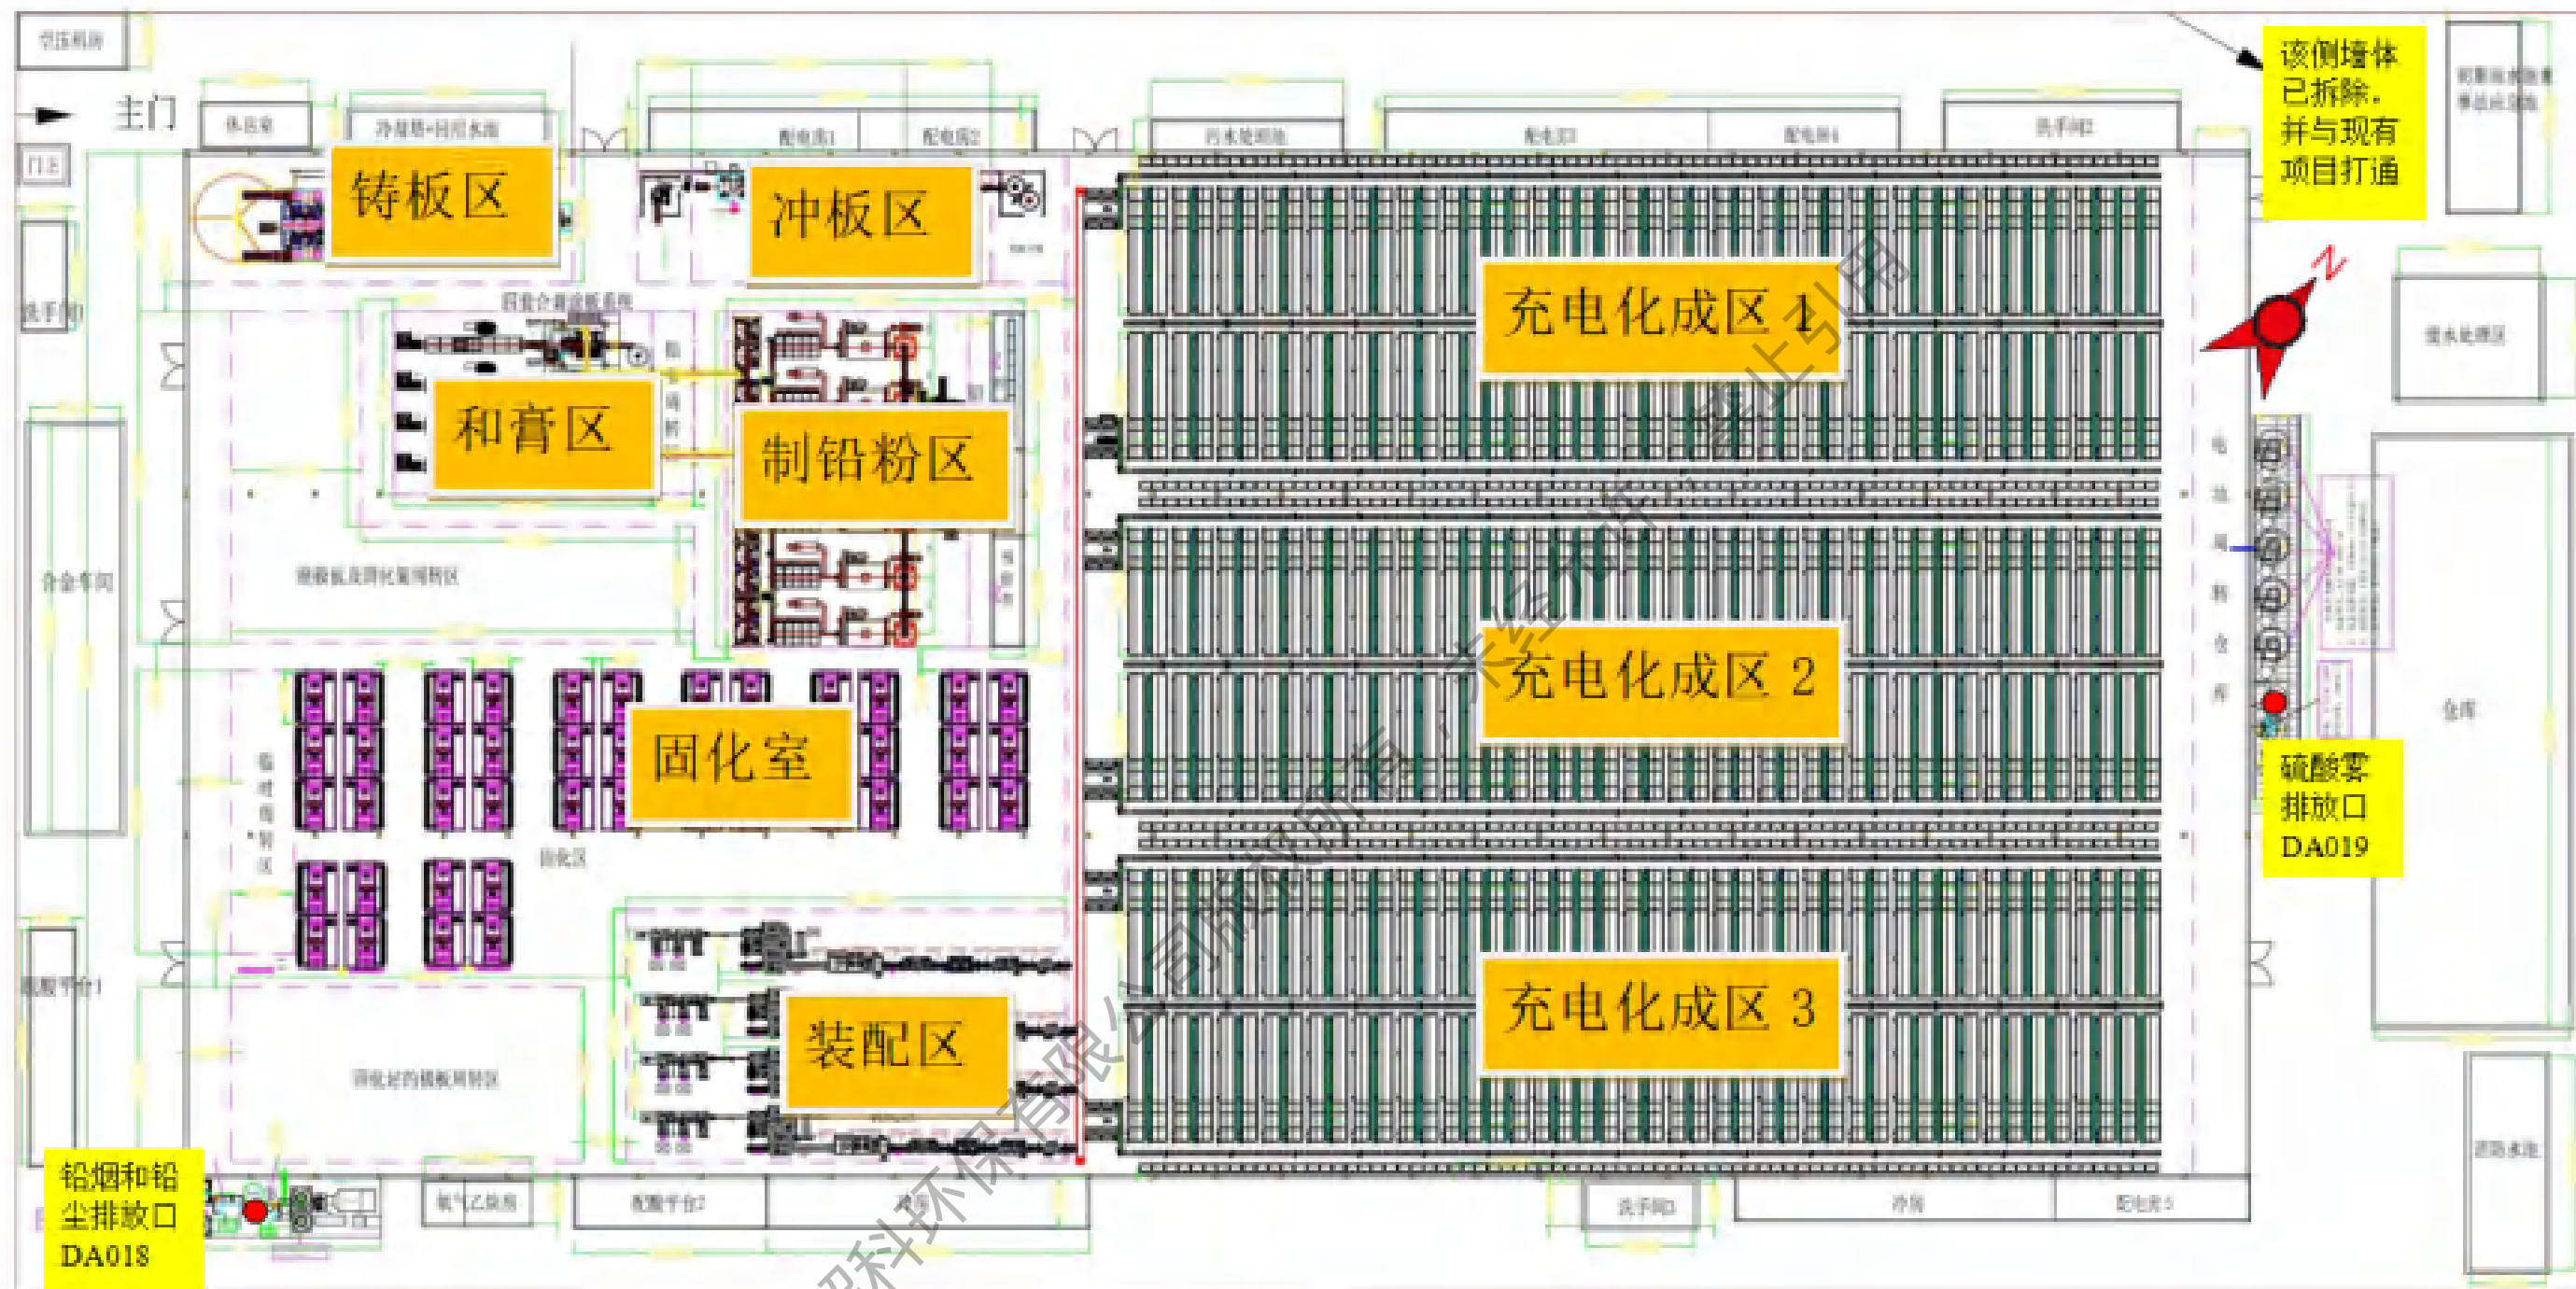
改扩建项目（重新报批）扩建部分平面布置图
